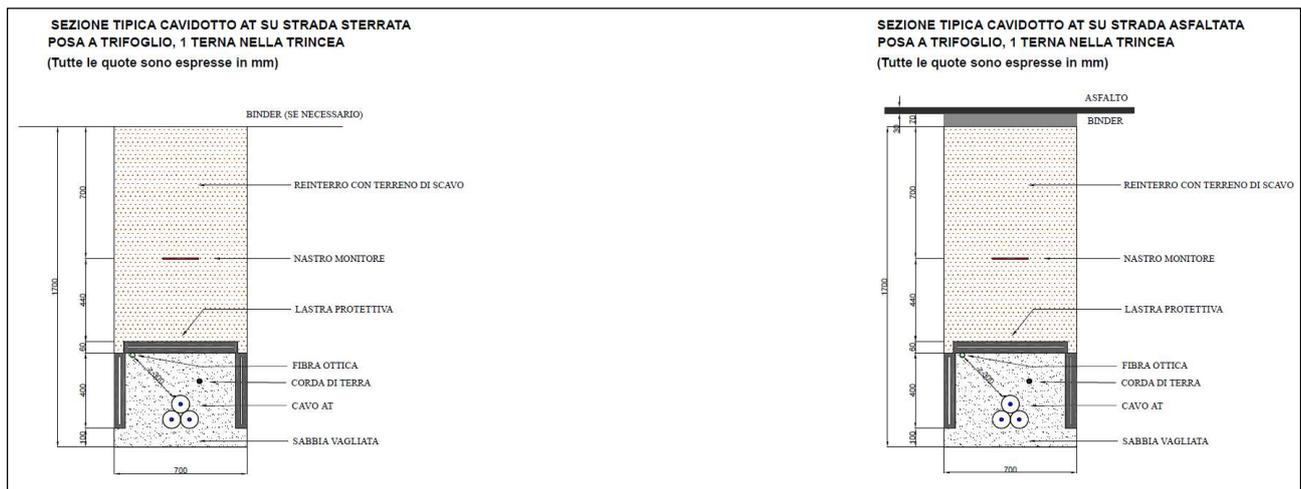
Sezione tipica del cavidotto AT
